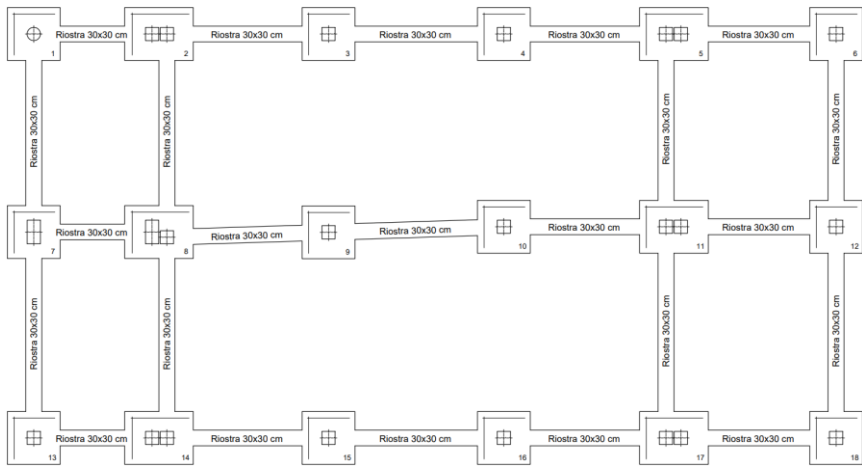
Distribución zapatas y pilares. 2024. Fuente: Propia
